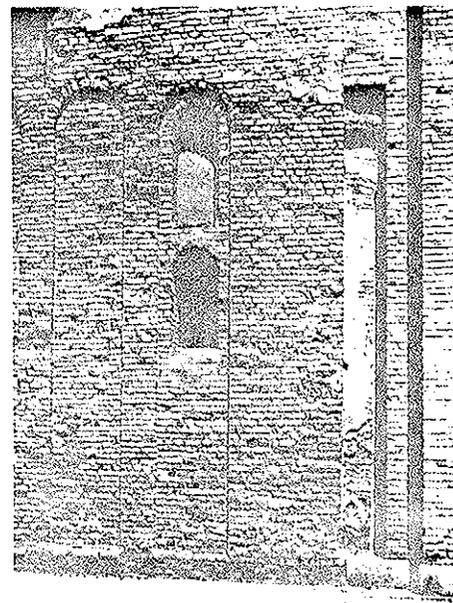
Pavia, S. Felice, muro sud, particolare
